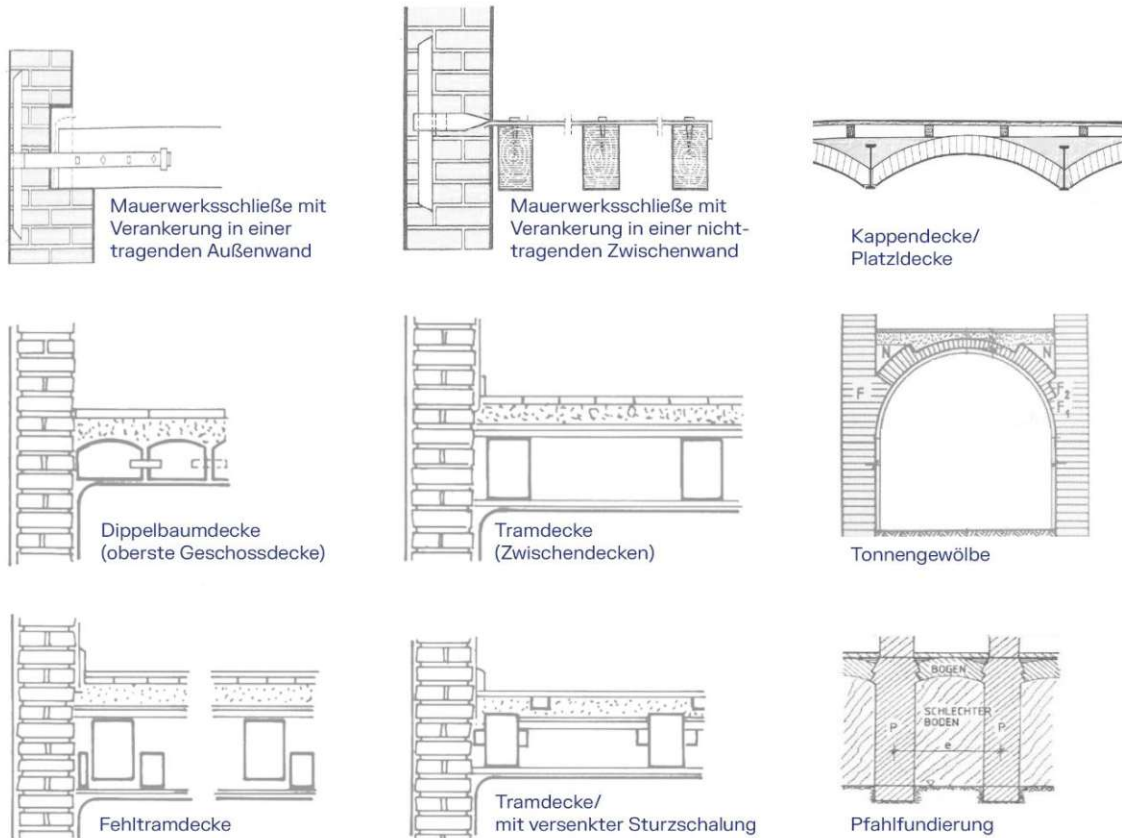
Details von Decken, Böden, Fundamenten und Verbindungen von Wand und Decke in einem typischen Gründerzeithaus © Andreas Kolbitsch, Bautechnische Analysen und Statik historischer Baukonstruktionen, Wien 2015.
